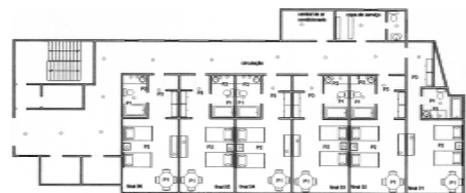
Planta baixa do pavimento-tipo do setor de hospedagem do Hotel H.
